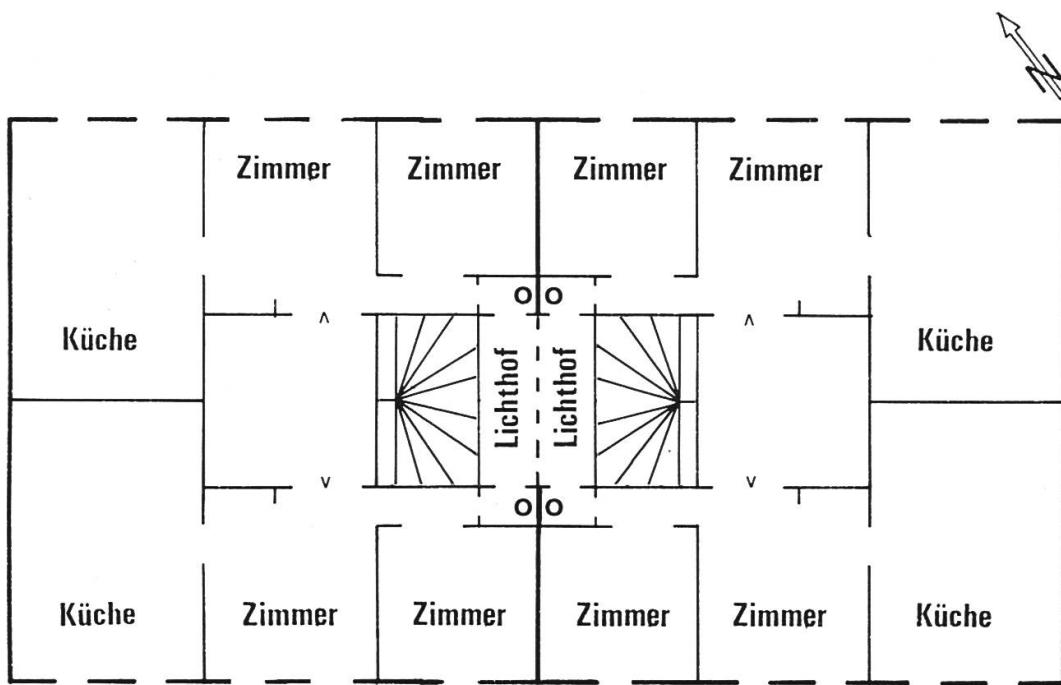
Murtenstrasse 20–30 von 1862. Grundrissskizze von zwei Häusern.
